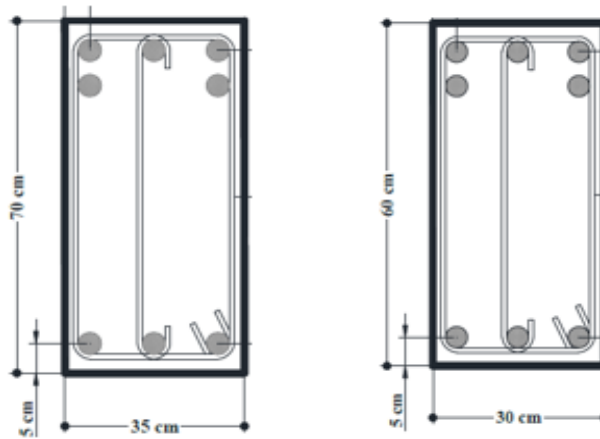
Armado tipo de vigas de edificio de CR de 6 niveles $Q=4$ (Hernández, 2016)
